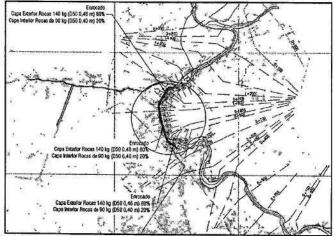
Plano en planta de la obra de protección marginal del río Sororia - Fuente: Alternativa Ambiental S.A.S, 2025.
